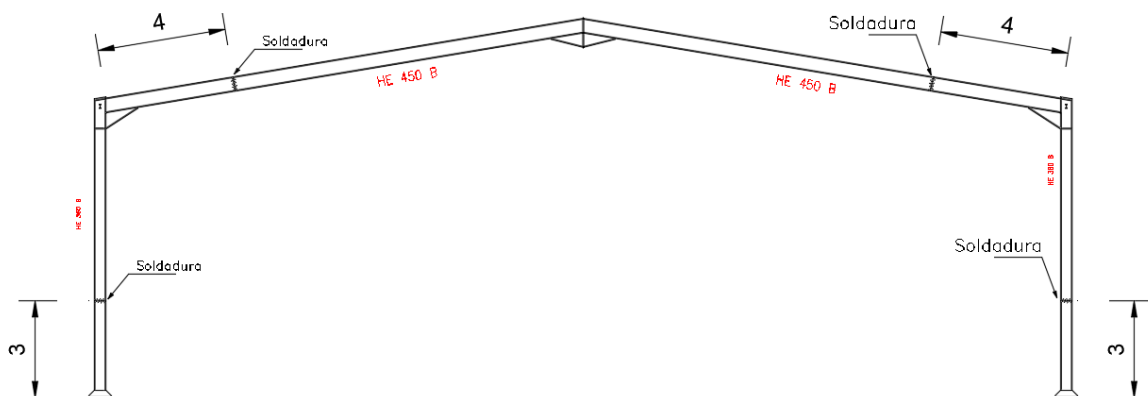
Posición de las soldaduras de unión entre perfiles.
